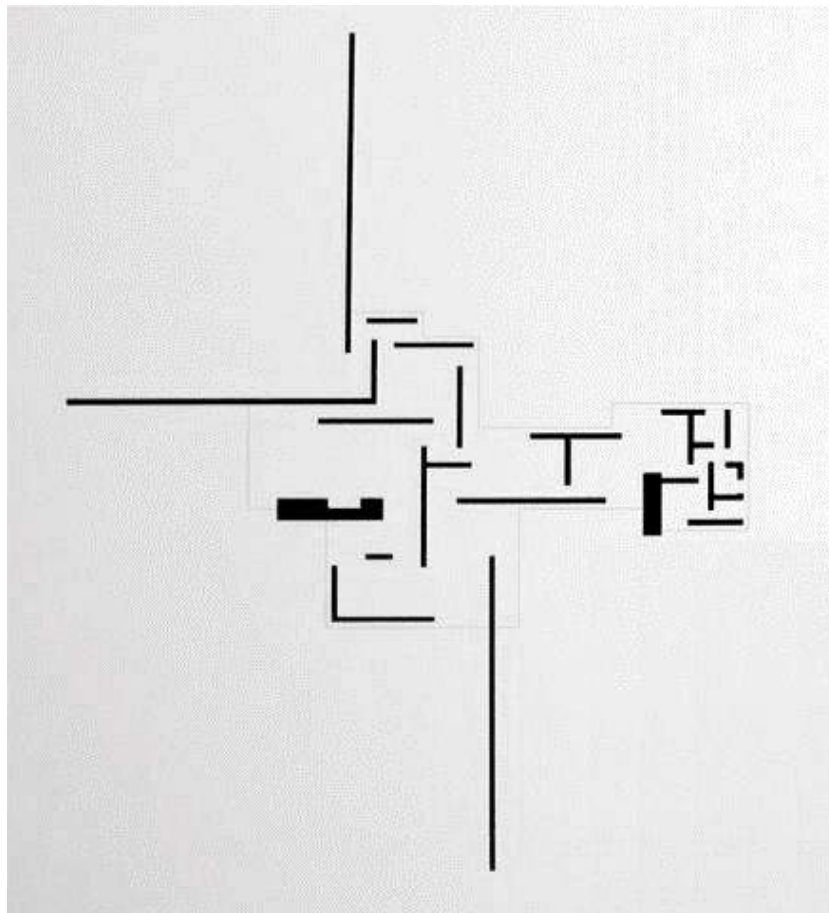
Planta de Brick Country House, 1924, Neubelsberg, por L. Mies Van der Rohe.
